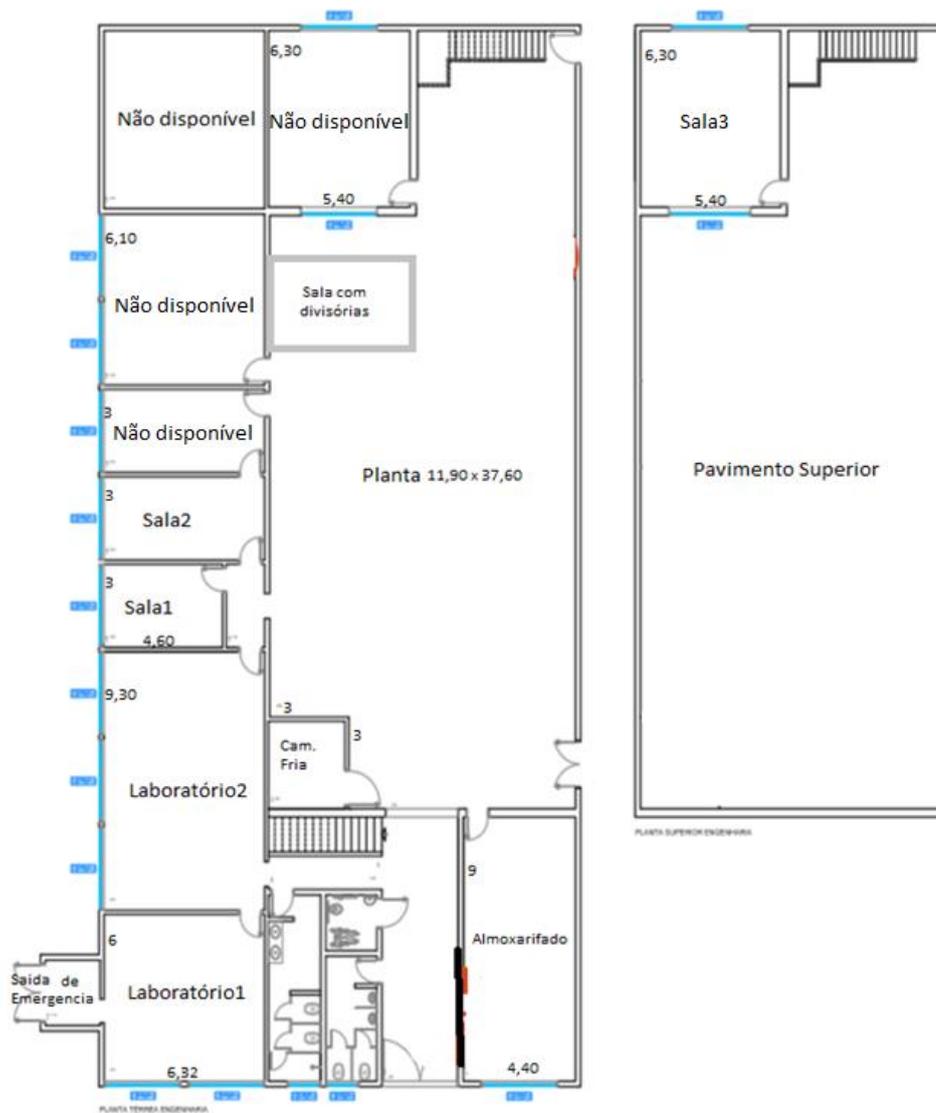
Planta Baixa da área de implantação de planta piloto multiusuário
